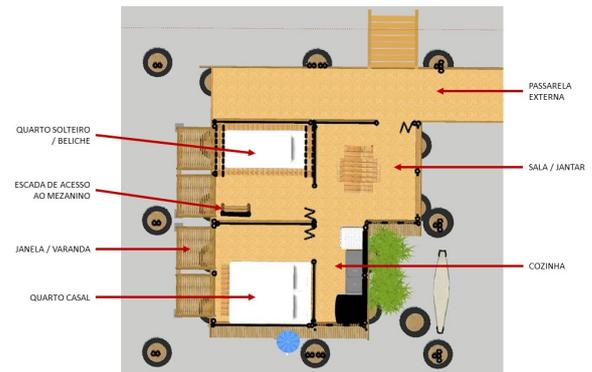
Planta baixa da configuração térrea. Fonte: elaborada pelos autores.
